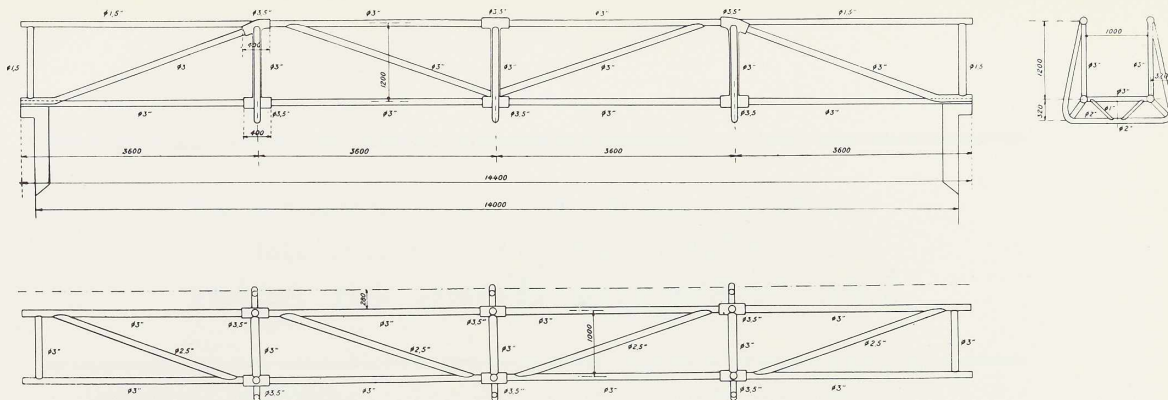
Elévation, plan et section de la passerelle de Wiesberg (Autriche).
